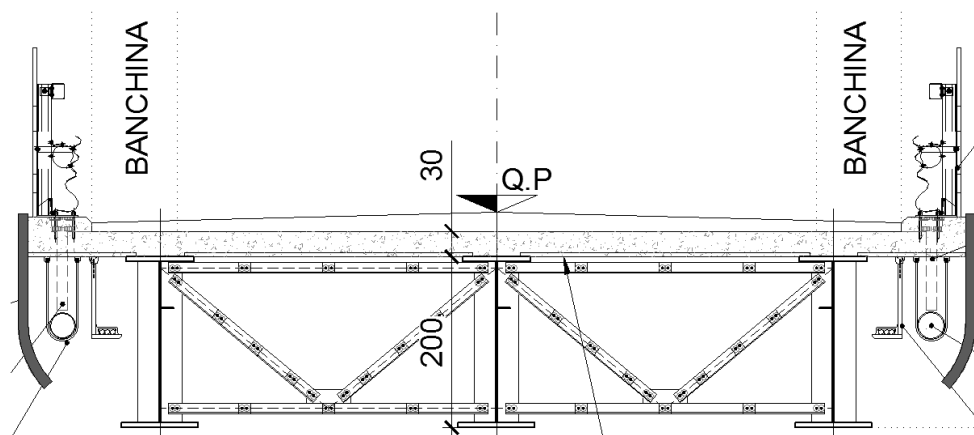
Sezione trasversale dell'impalcato campata centrale
